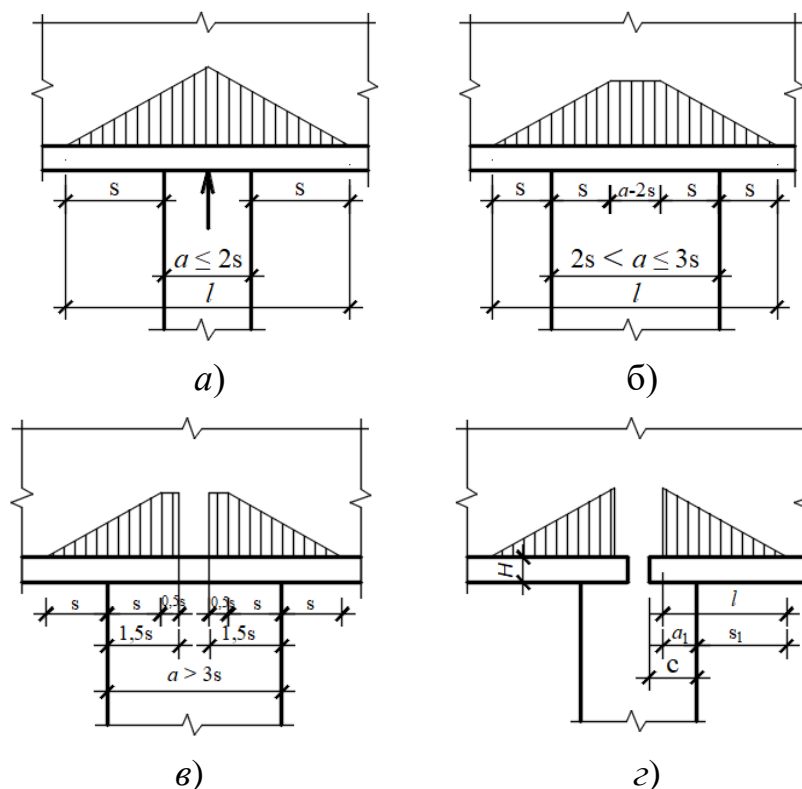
Розподіл тиску в кладці над опорами нерозрізних (а, б, в) і однопрольотних (г) балок:
